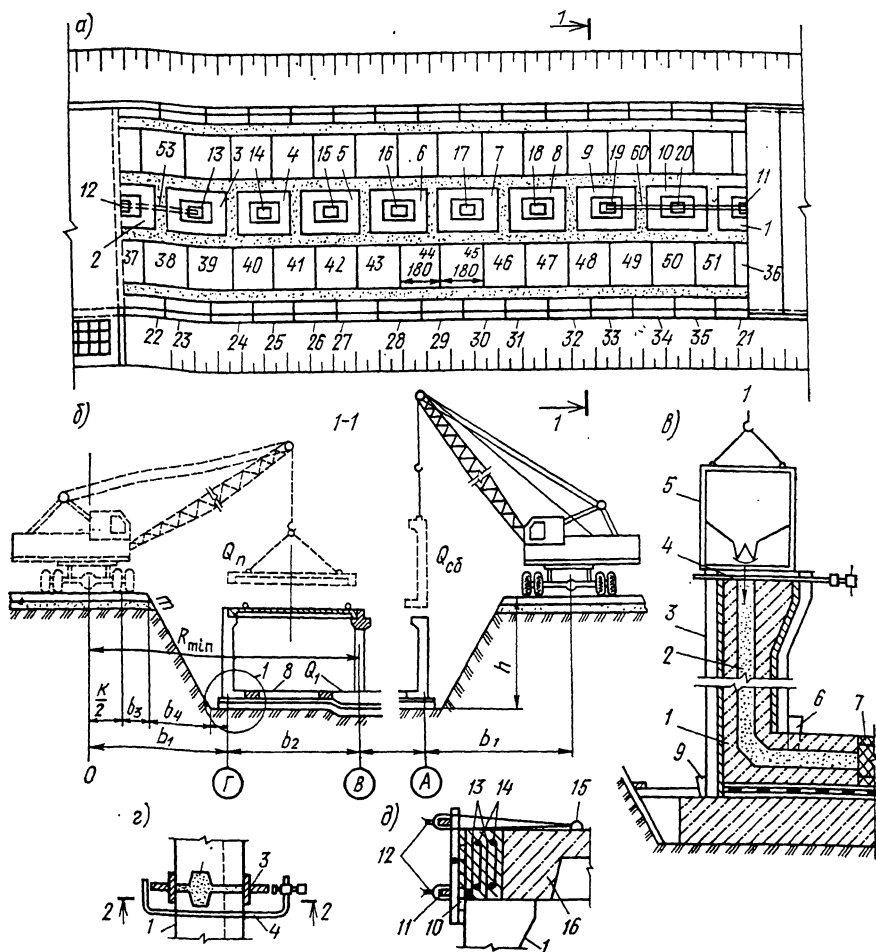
Схема монтажа подземного пешеходного перехода
